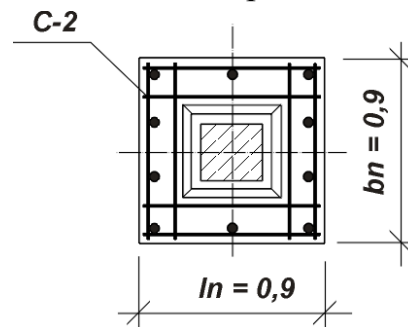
Схема армирования подколонника арматурной сеткой С-2
